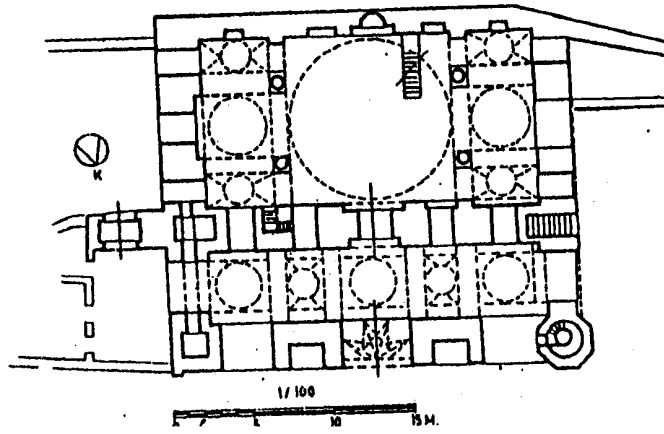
مسقط أفقي لجامع اق اورفا
